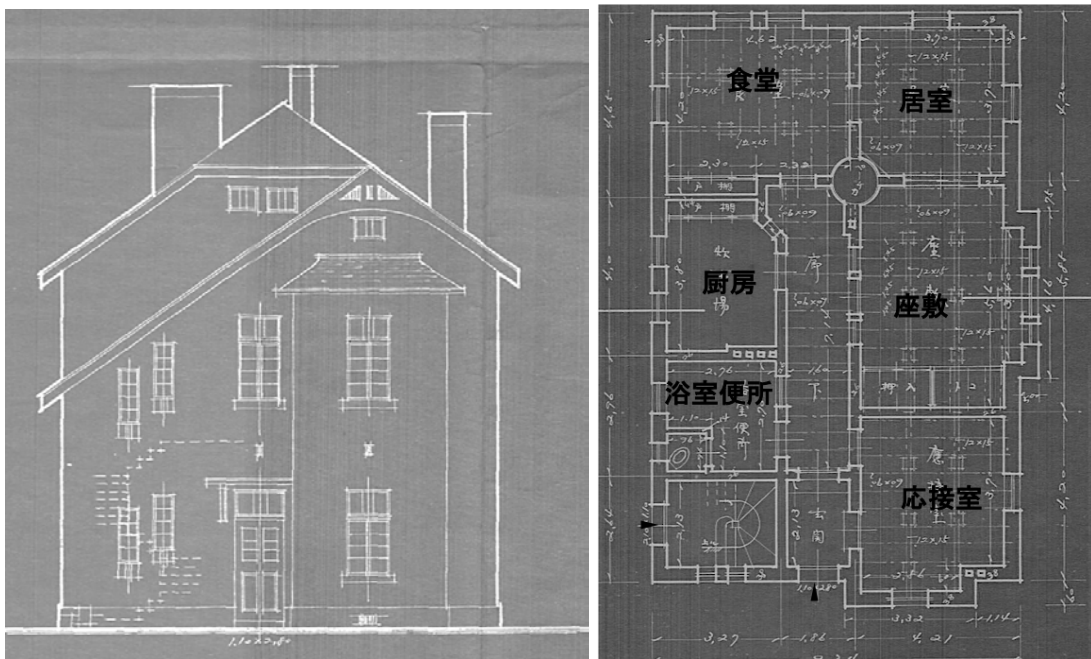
⑩の立面図と平面図 (「1930-0255」より)
